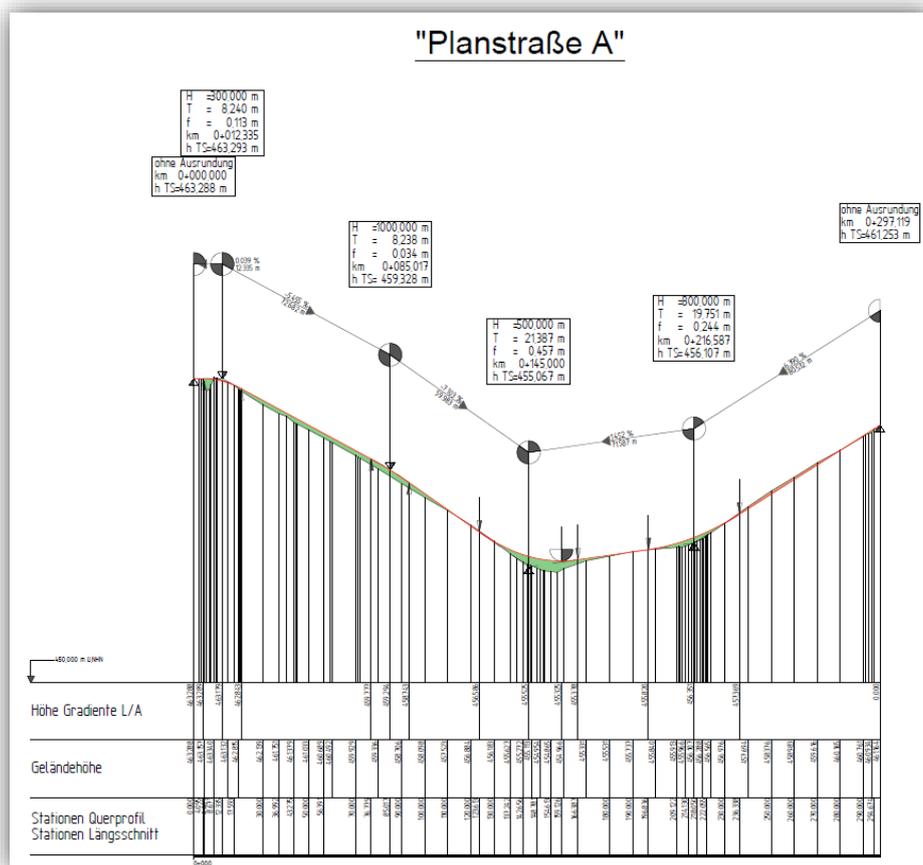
Höhenplan Planstraße A Baugebiet „Am Schloss“
